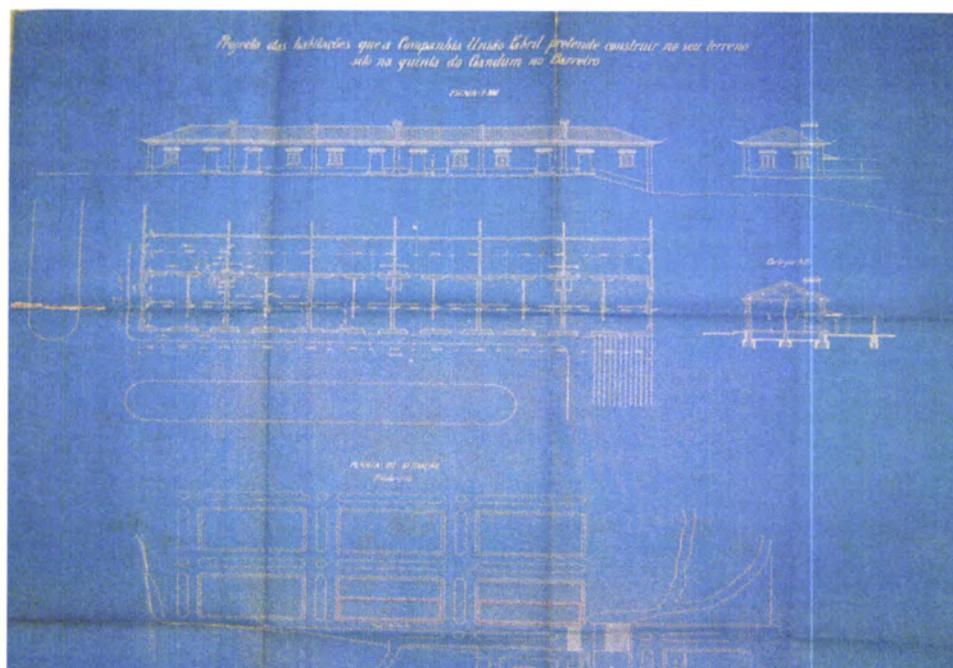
Planta do Bairro Operário. Projecto das habitações a construir.
